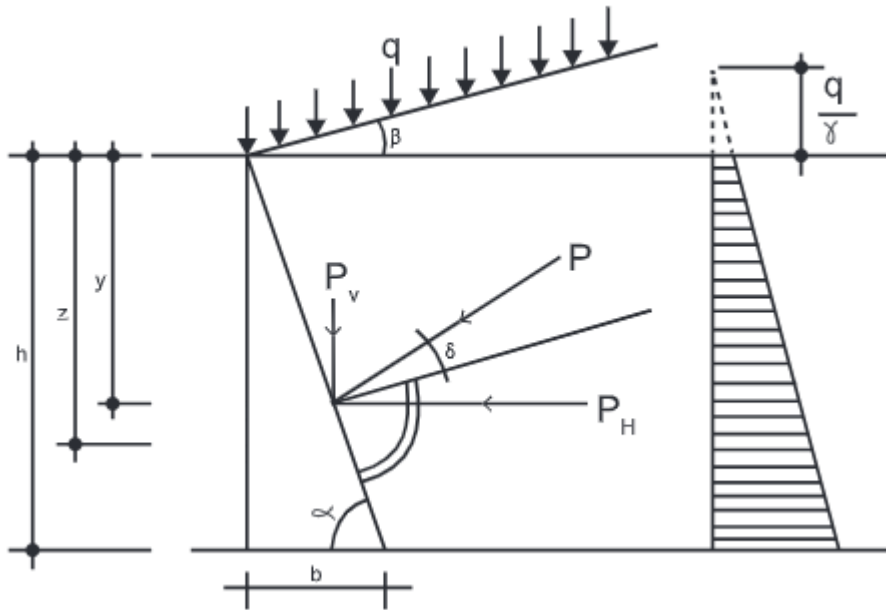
Croquis de un muro de trasdós plano. (NB1225002-1)
